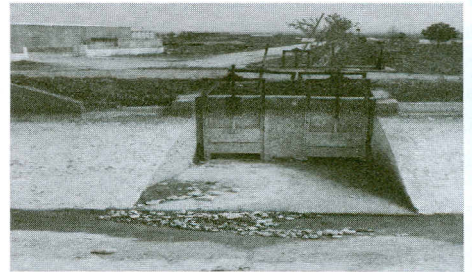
Urfa ana kanalında yanmış ve çatlamış beton kaplaması
